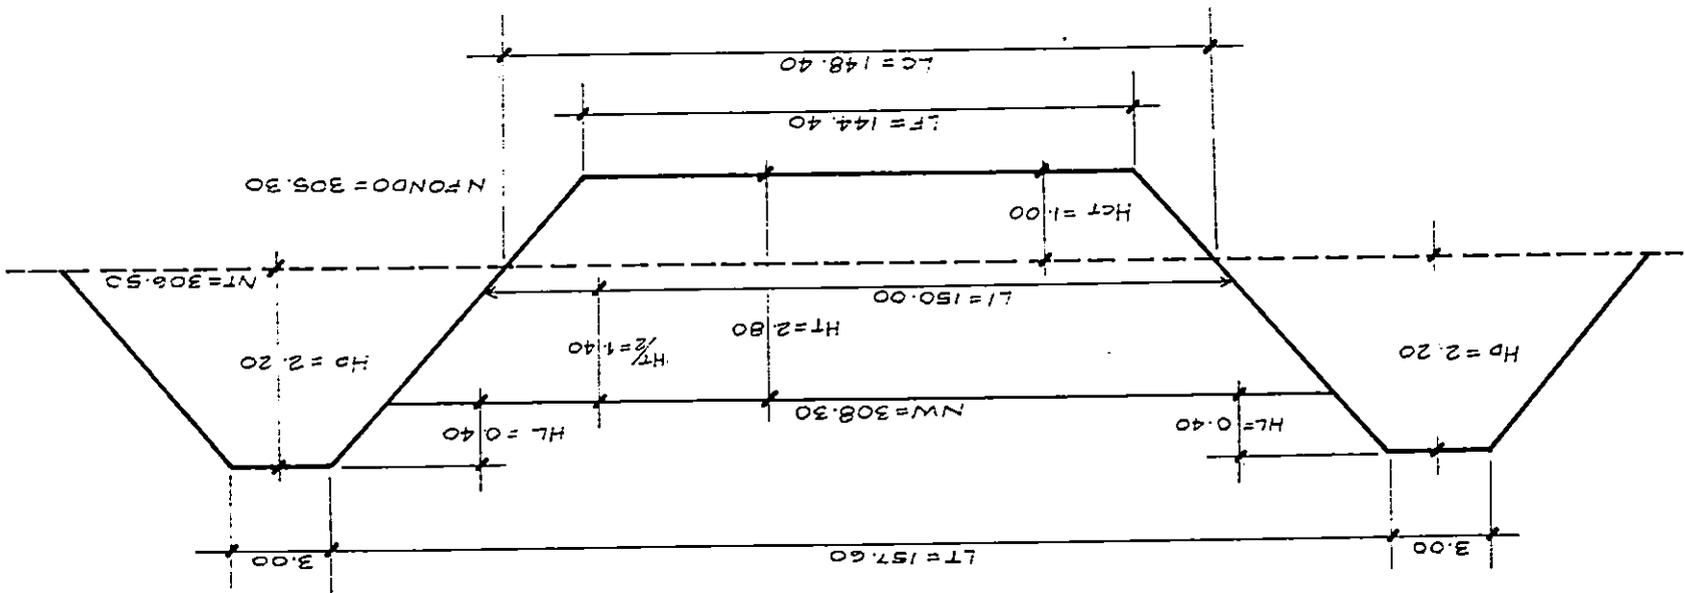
SECCION LONGITUDINAL DE LAGUNA FACULTATIVA SECUNDARIA "C"
